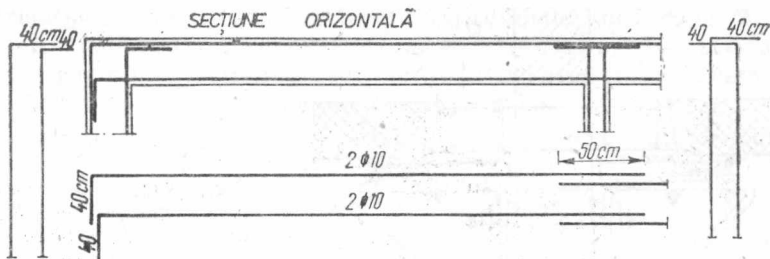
Armarea centurilor la pereții exteriori de colț la o structură cu diafragme din beton armat monolit executate în cofraje glisante.
